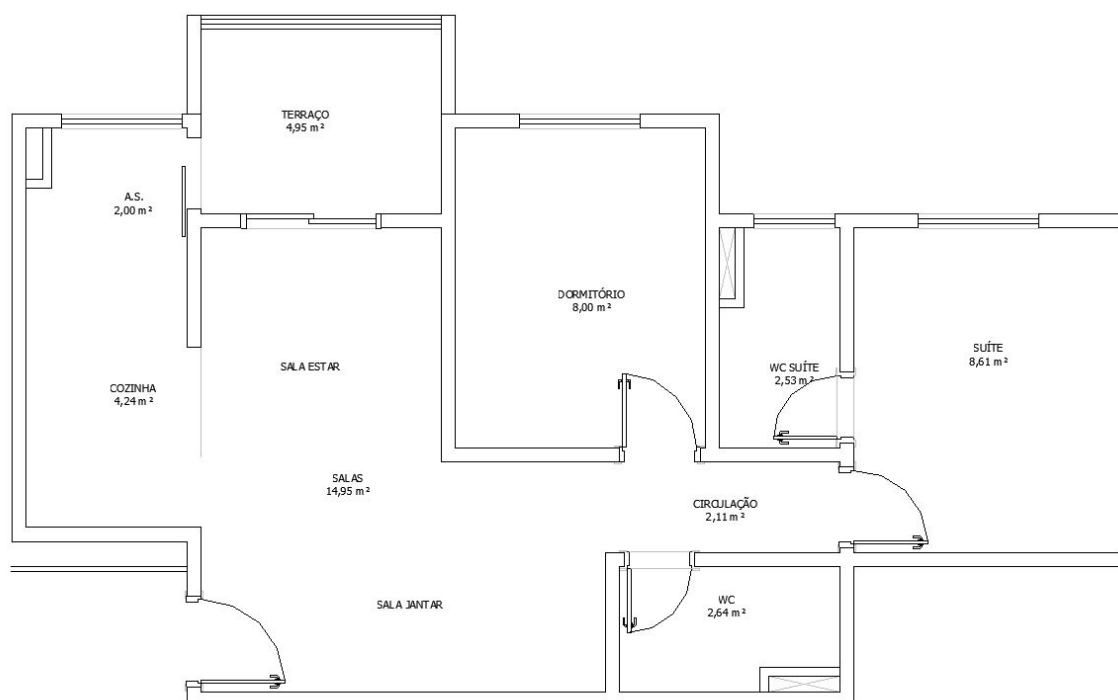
Blocos 2 e 4 – planta apartamento 1 dormitório e 1 suite.
